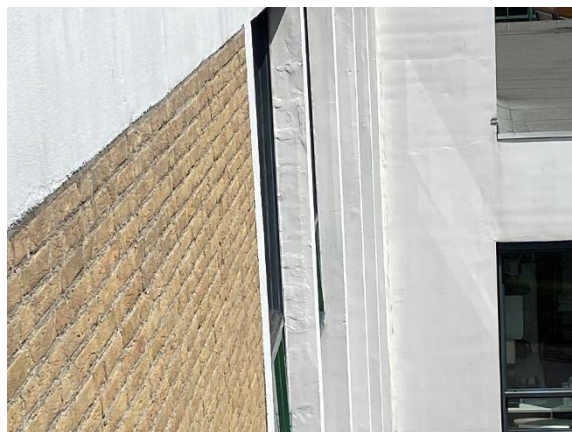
afgedrukt beton ter plaatse van dakrand bouwdeel D
